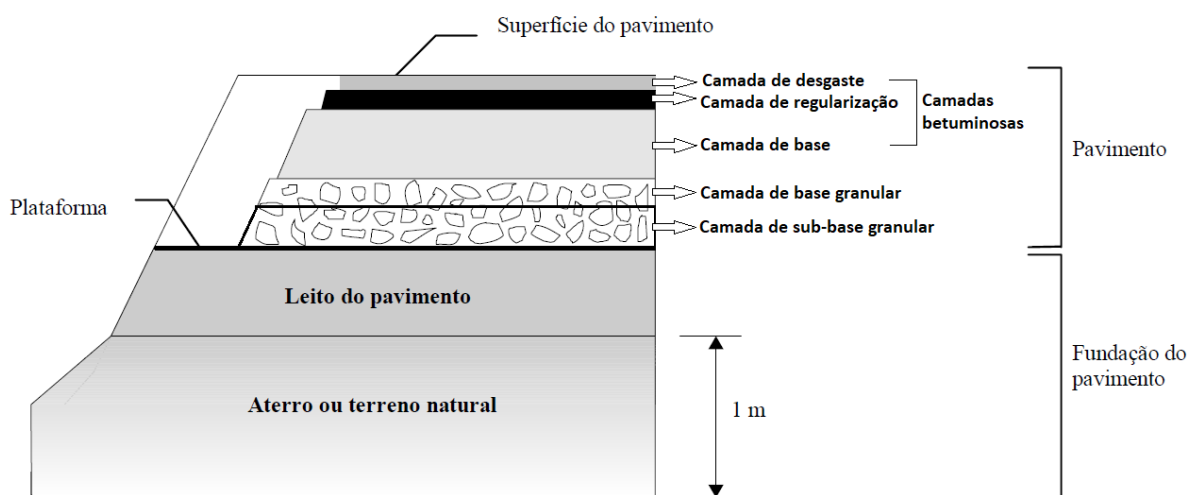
Constituição tipo de um pavimento rodoviário (Adaptado de Neves, 2009)
